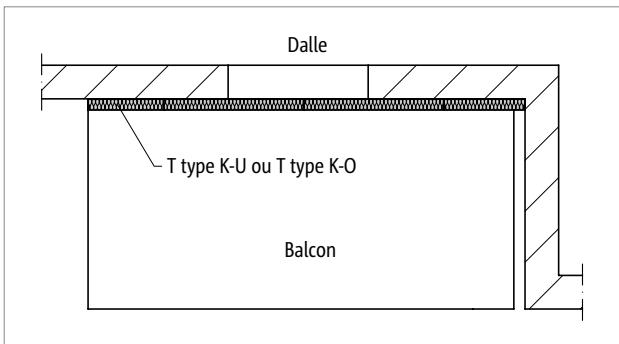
Schöck Isokorb® T types K-U/K-O : balcon dans le cas d'un décrochement de façade
